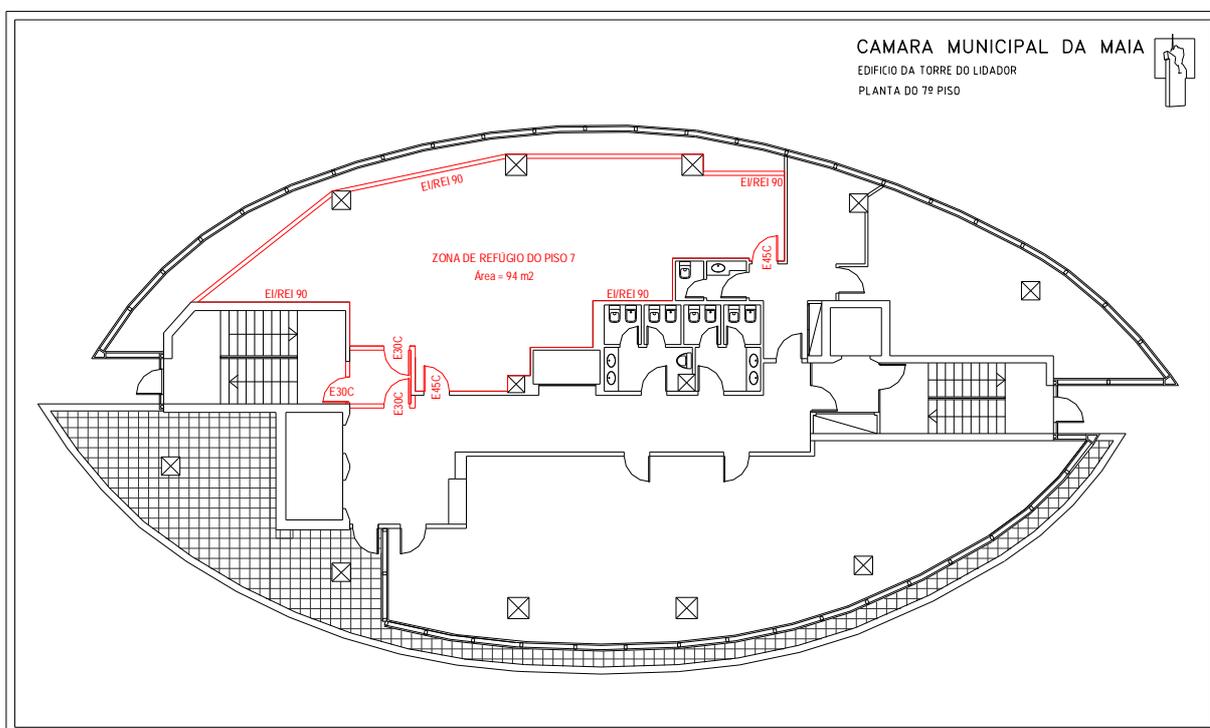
Planta da zona de refúgio do piso 7.
